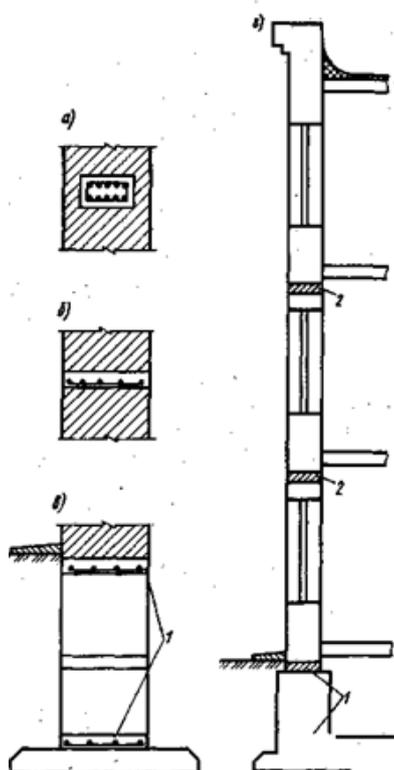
Размещение поясов армирования: 1 — пояса армирования в фундаменте; 2 — пояса армирования в стенах
